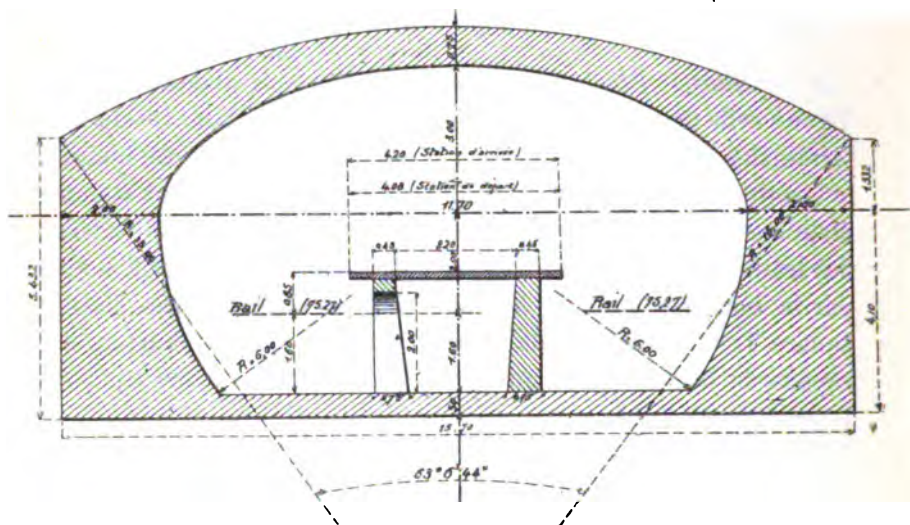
Stations « Place Gambetta ». Coupe transversale.
